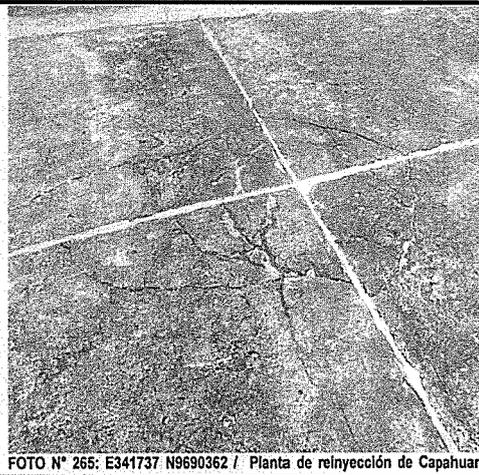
E341737 N9690362 / Planta de reinyección de Capahuari
